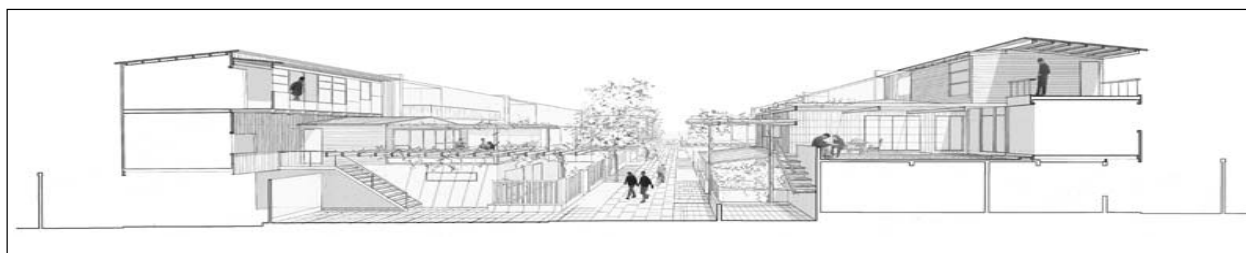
Imagen objetivo proyecto de título de Rodrigo Pedraza.
